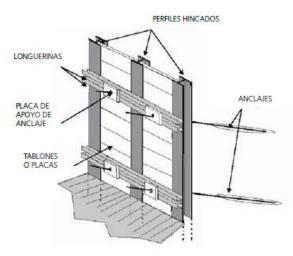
Esquema de un muro berlinés; Fuente: Revista BIT (55), Julio 2007.
